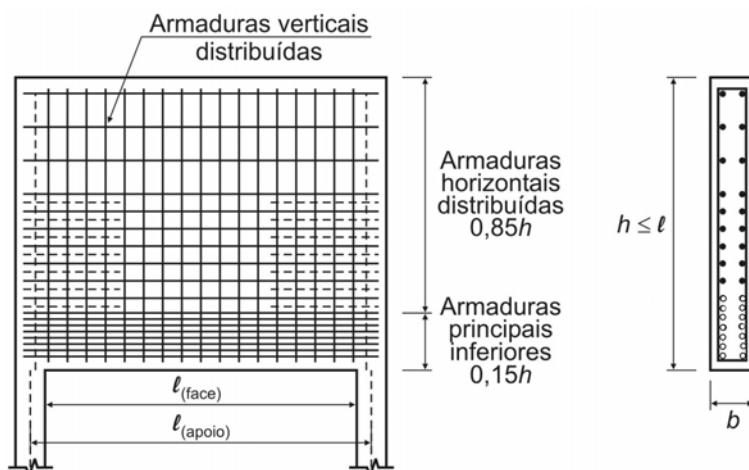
Armação típica de viga-parede com  $h \leq l$
